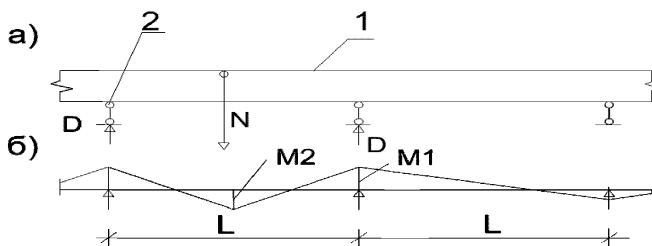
Расчетная схема монолитного пояса с нагелями:
